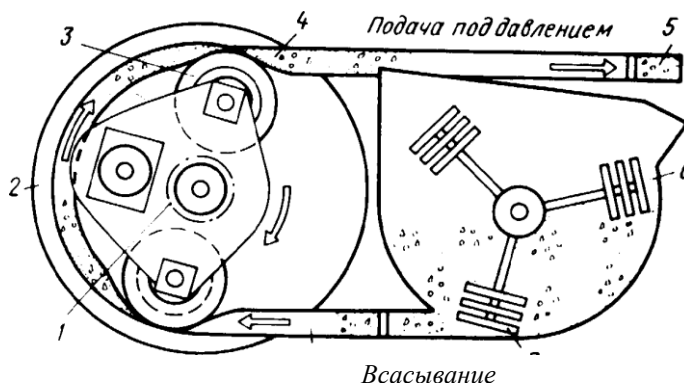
Схема ротационного бетононасоса: 1 – планетарная передача; 2 – неподвижный корпус; 3 – ролики; 4 – гибкий нейлоно-неопреновый шланг; 5 – бетоновод; 6 – приемный бункер
